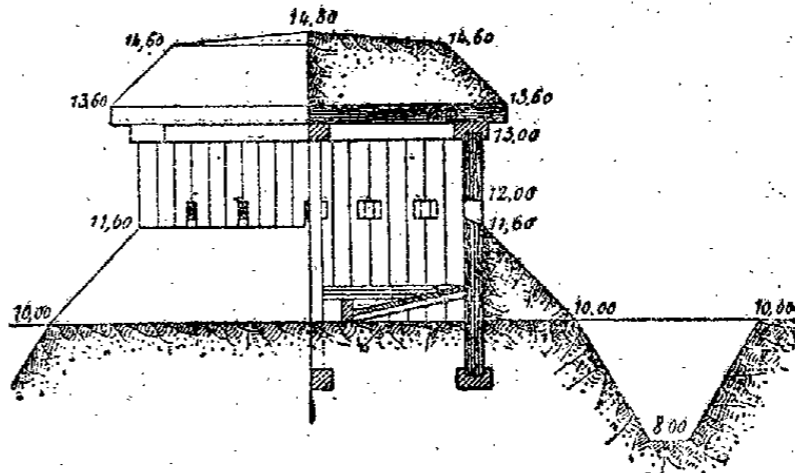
Coupe et élévation d'un blockhaus ordinaire.
